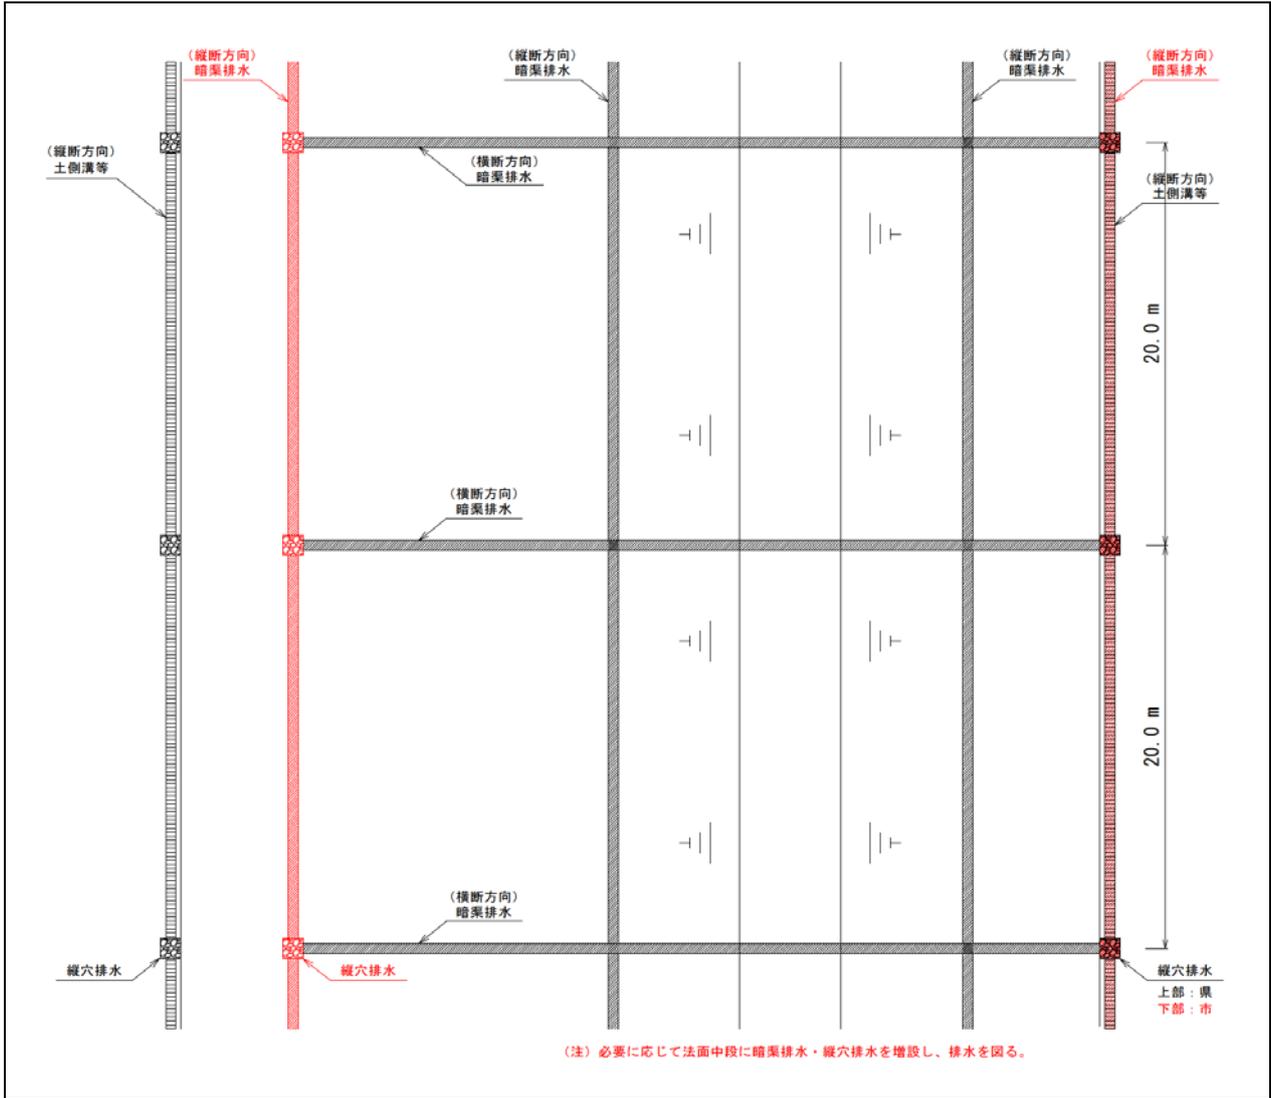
第3種建設発生土の排水処理平面図 (赤字：市施工 黒字：県施工)
